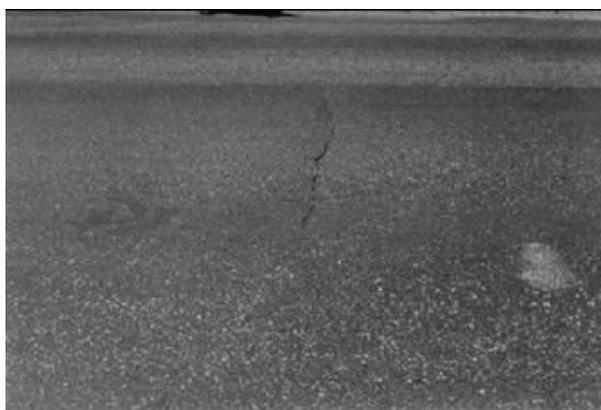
Fisura Longitudinal y Transversal – Baja Severidad
